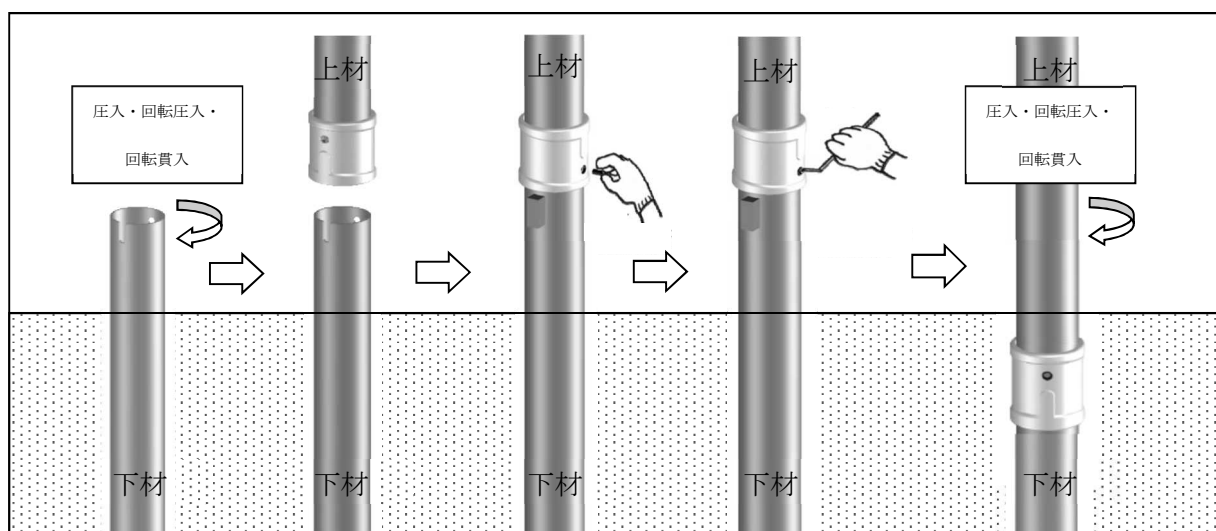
パイルフィット継手を有する補強材の施工概要図
